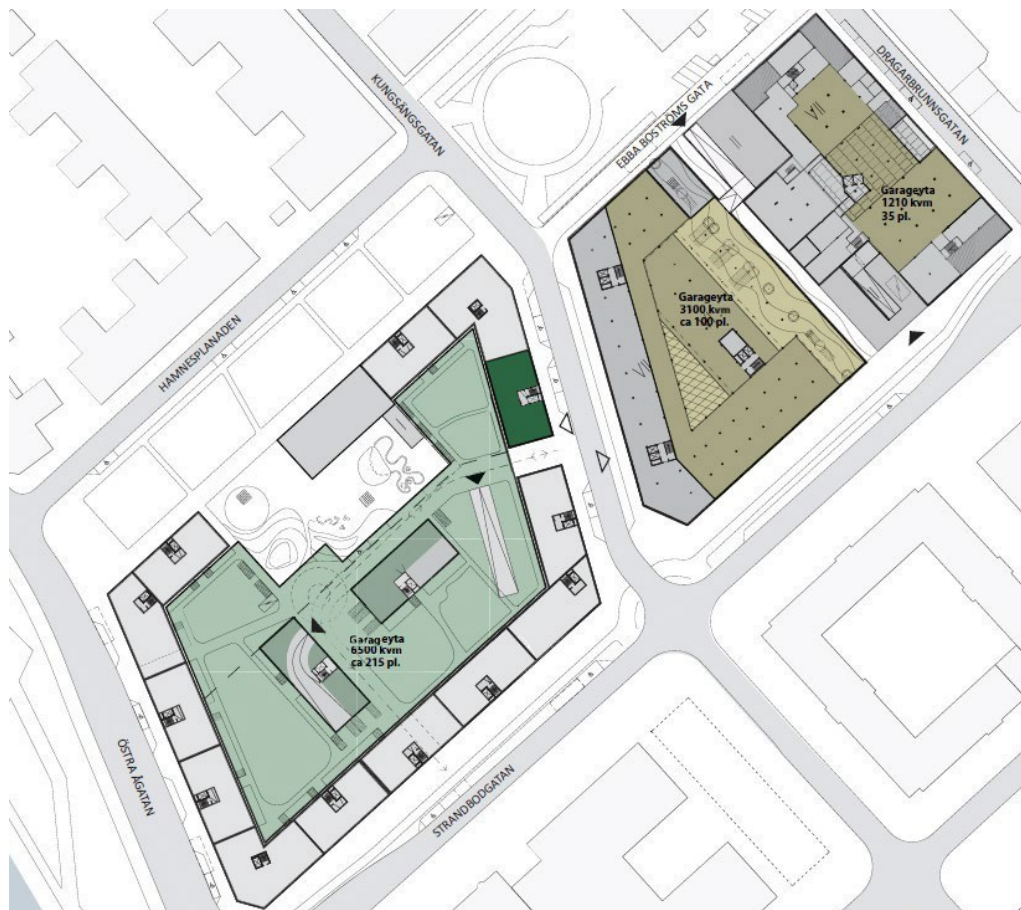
Illustrationsplan över möjlig utformning av underjordiska garage och nedfarter (svarta pilar).
